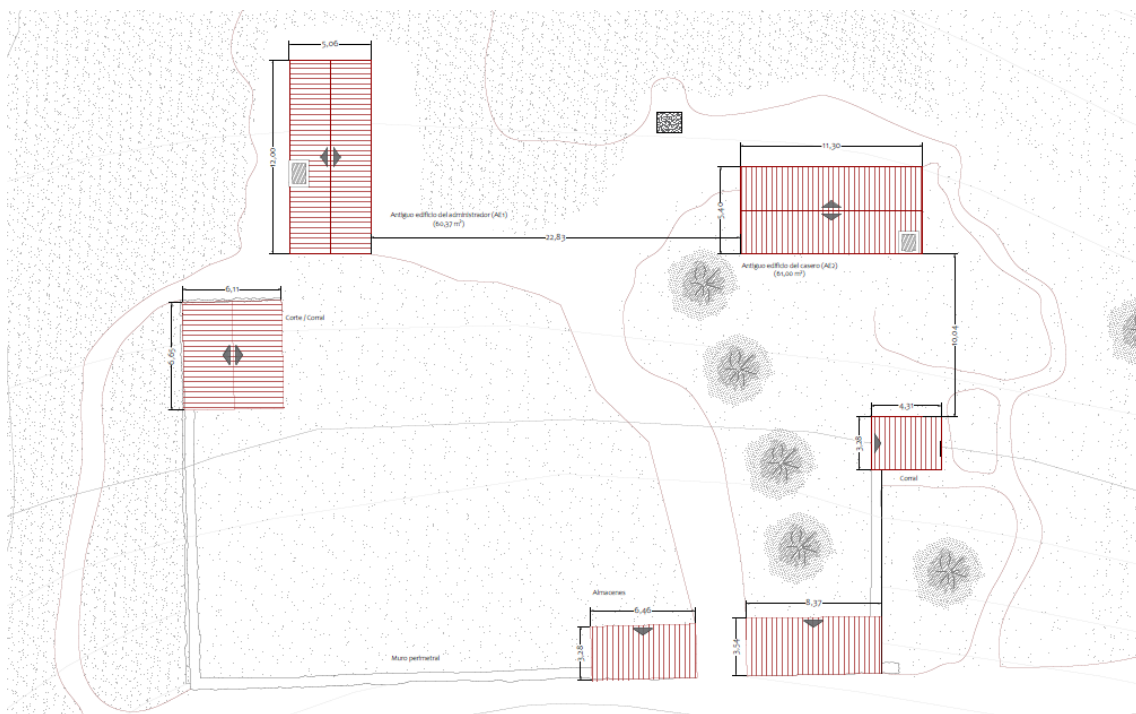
Interpretación de la planta de la primera granja de Ulló, en el año 1726.
